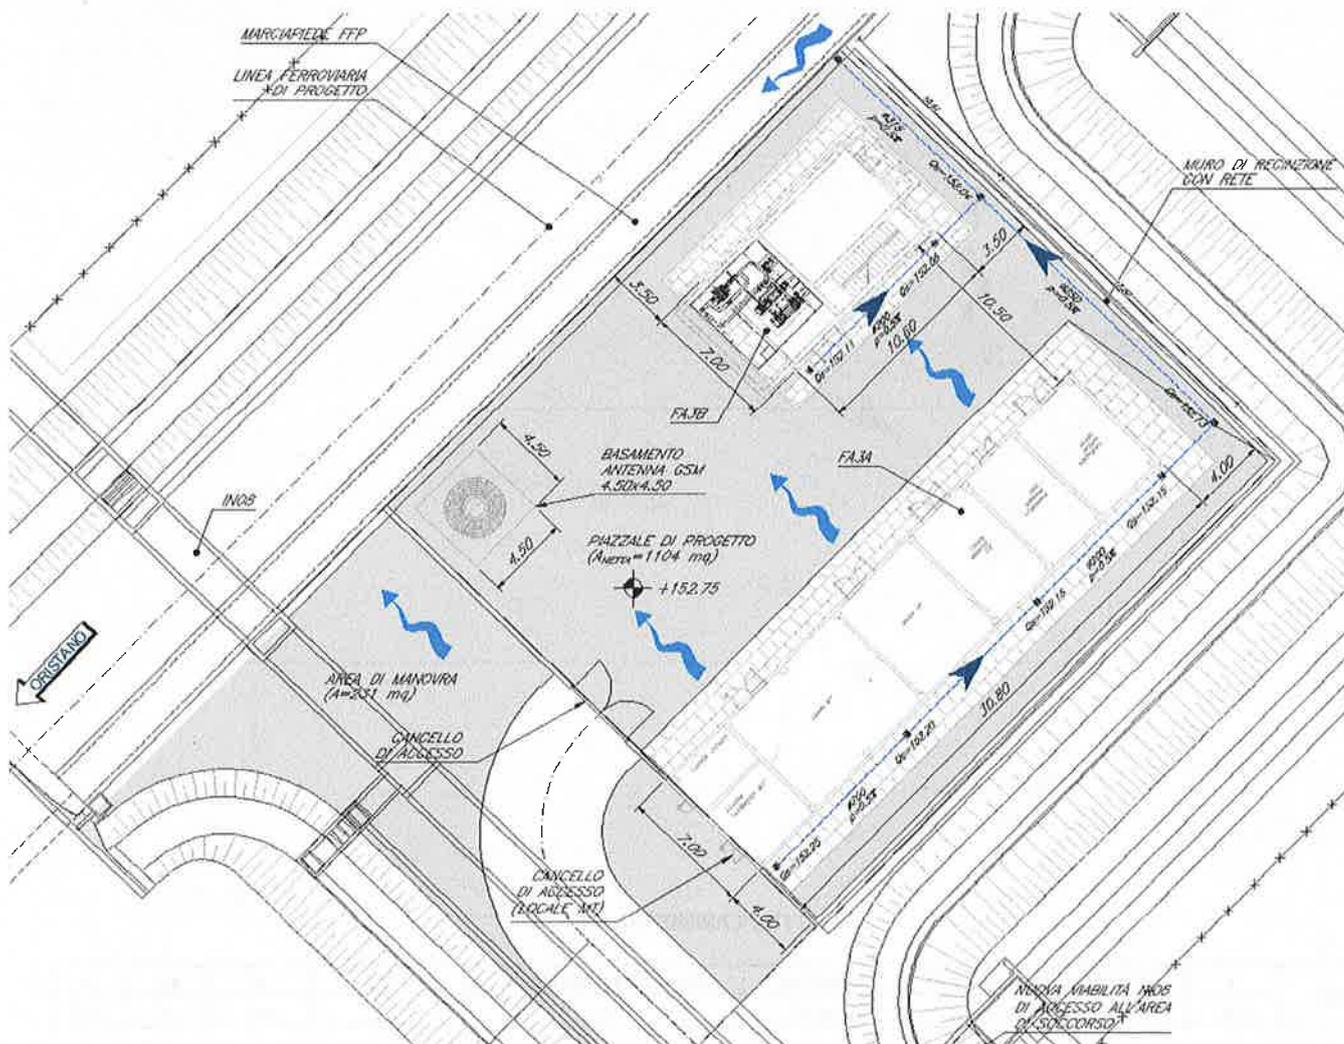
PLANIMETRIA PIAZZALE RI52
